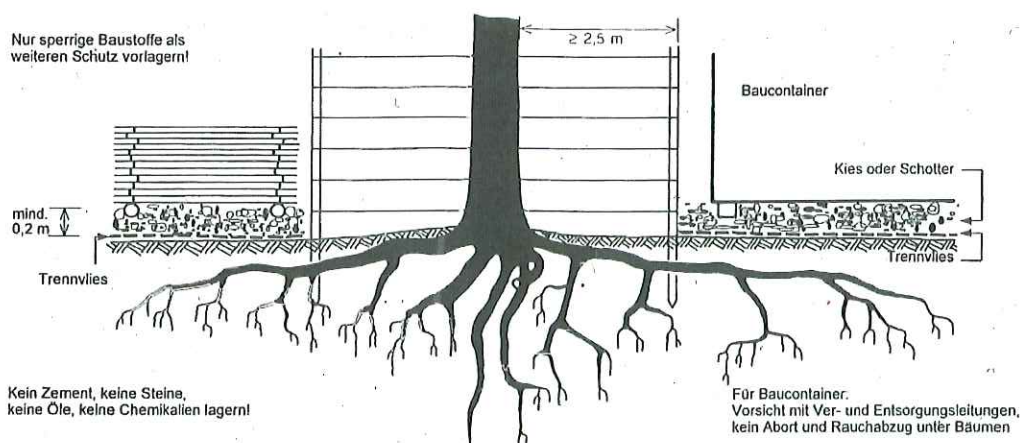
Schadensbegrenzung bei Baustelleneinrichtung und Lagerung im Wurzelbereich
